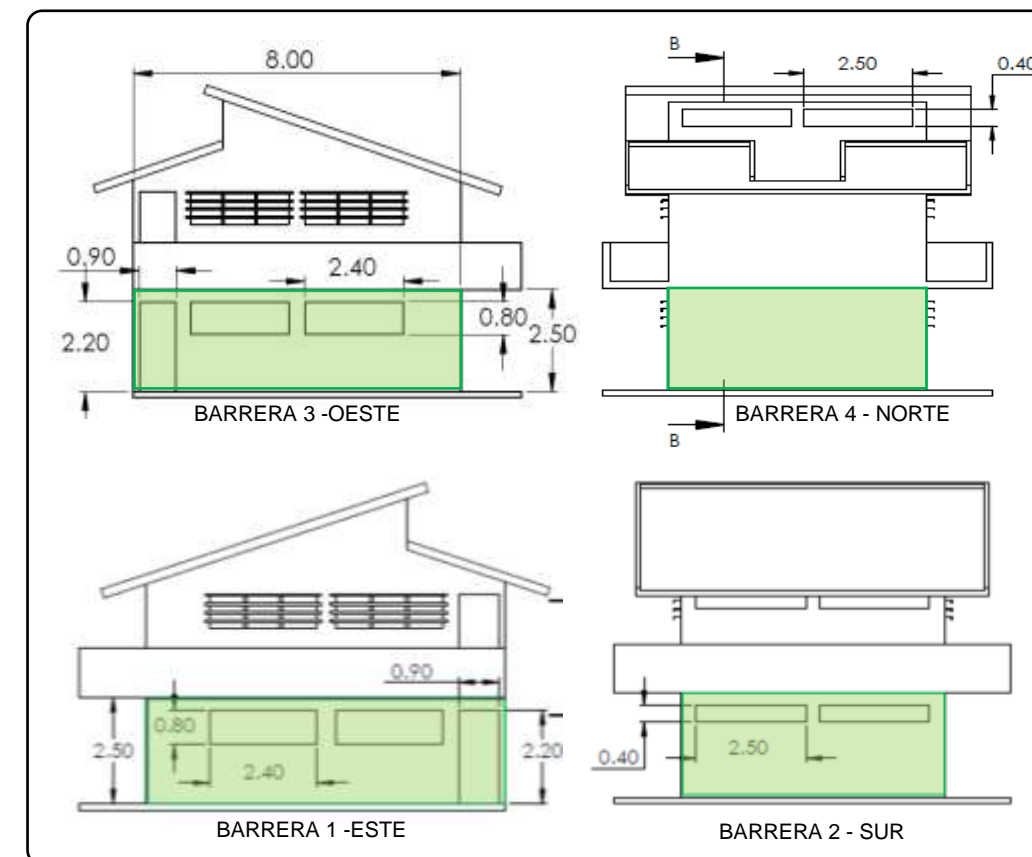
Planos ilustrativos del espacio de estudio Ruido de Fondo en Planta Baja. Fuente: Elaboración propia
